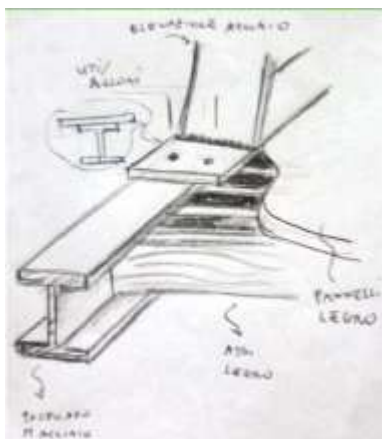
Représentation de : poutre de rive, planches secondaires en bois, panneaux de marche en bois, fixation boulonnée de la structure d'élévation en acier - Groupe Brontolo
